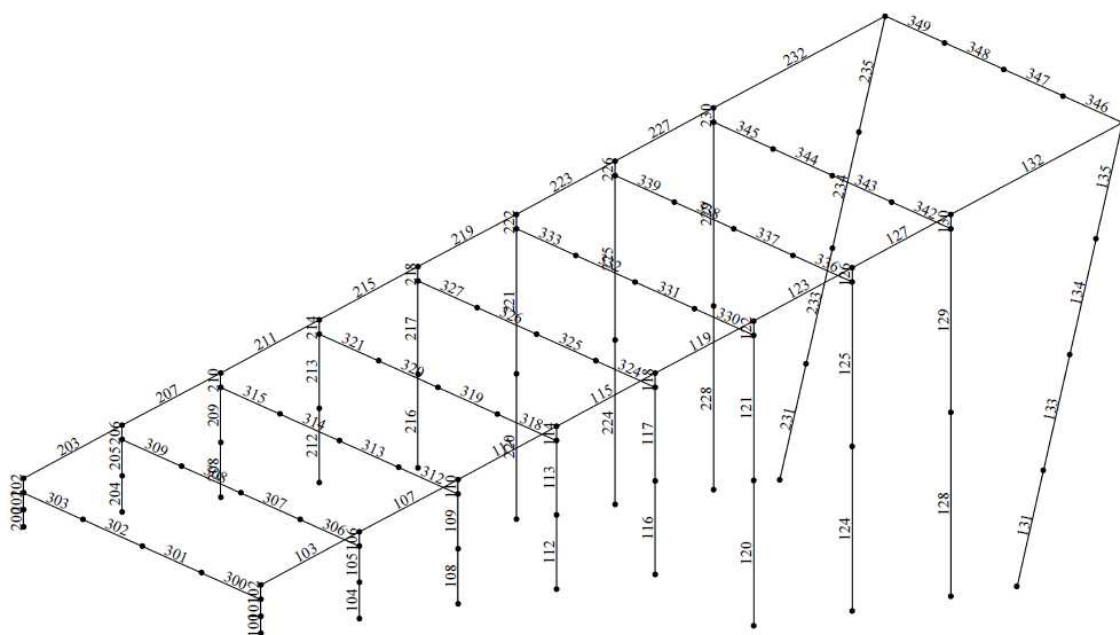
Rappresentazione del modello agli elementi finiti della struttura, con indicazione degli elementi beam
